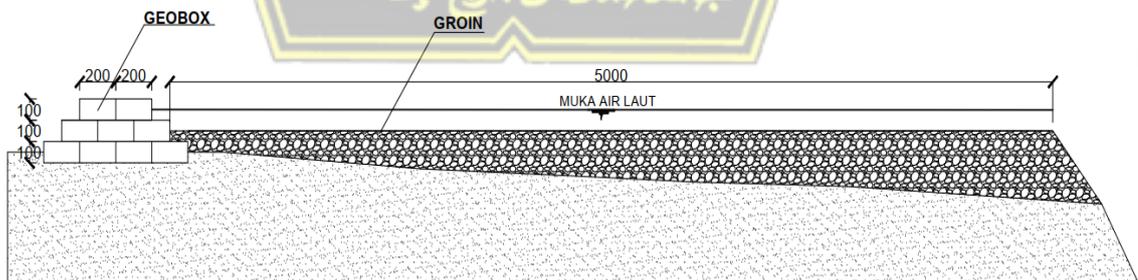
Denah Alternatif 1 (Area Tepi Pantai)
